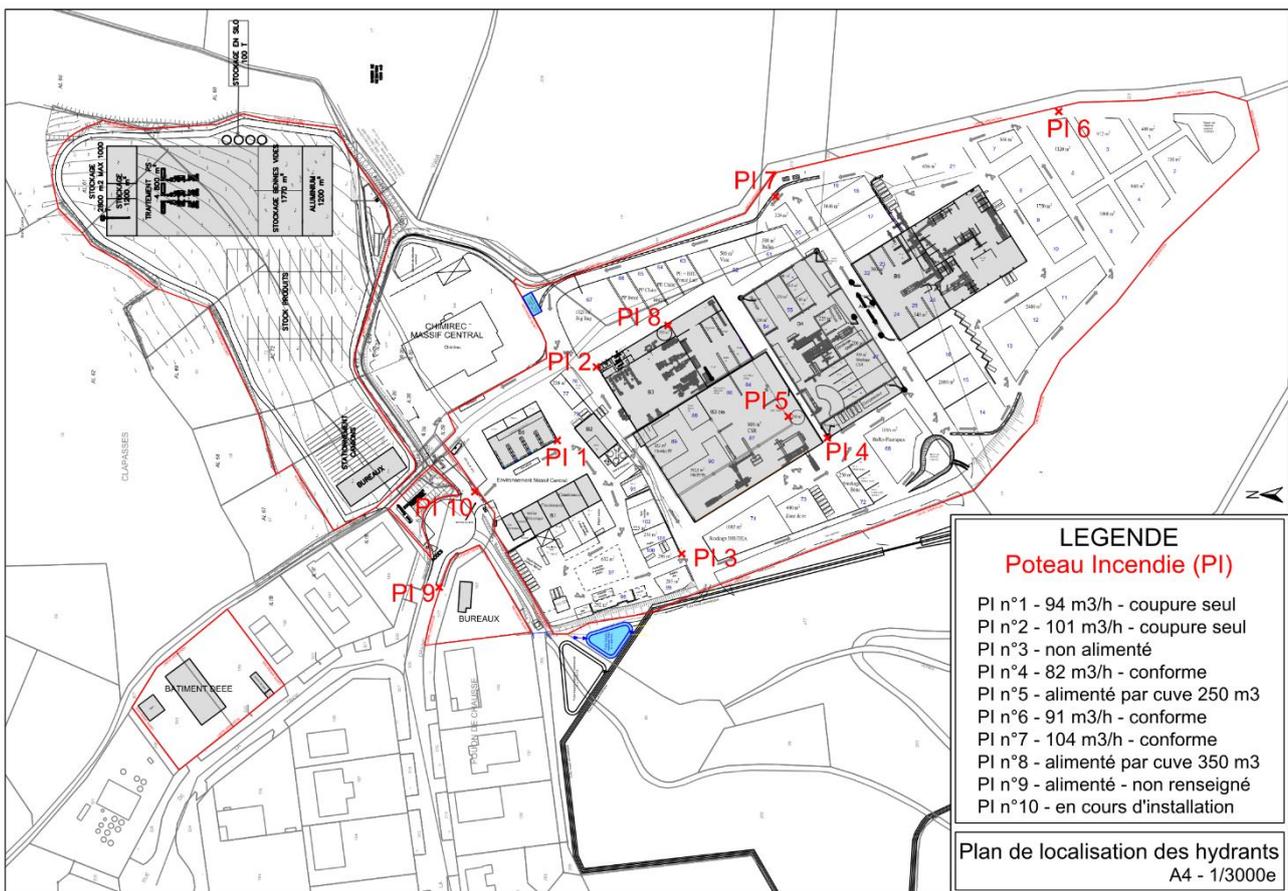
Plan de localisation des hydrants sur le site central d'Environnement Massif Central
